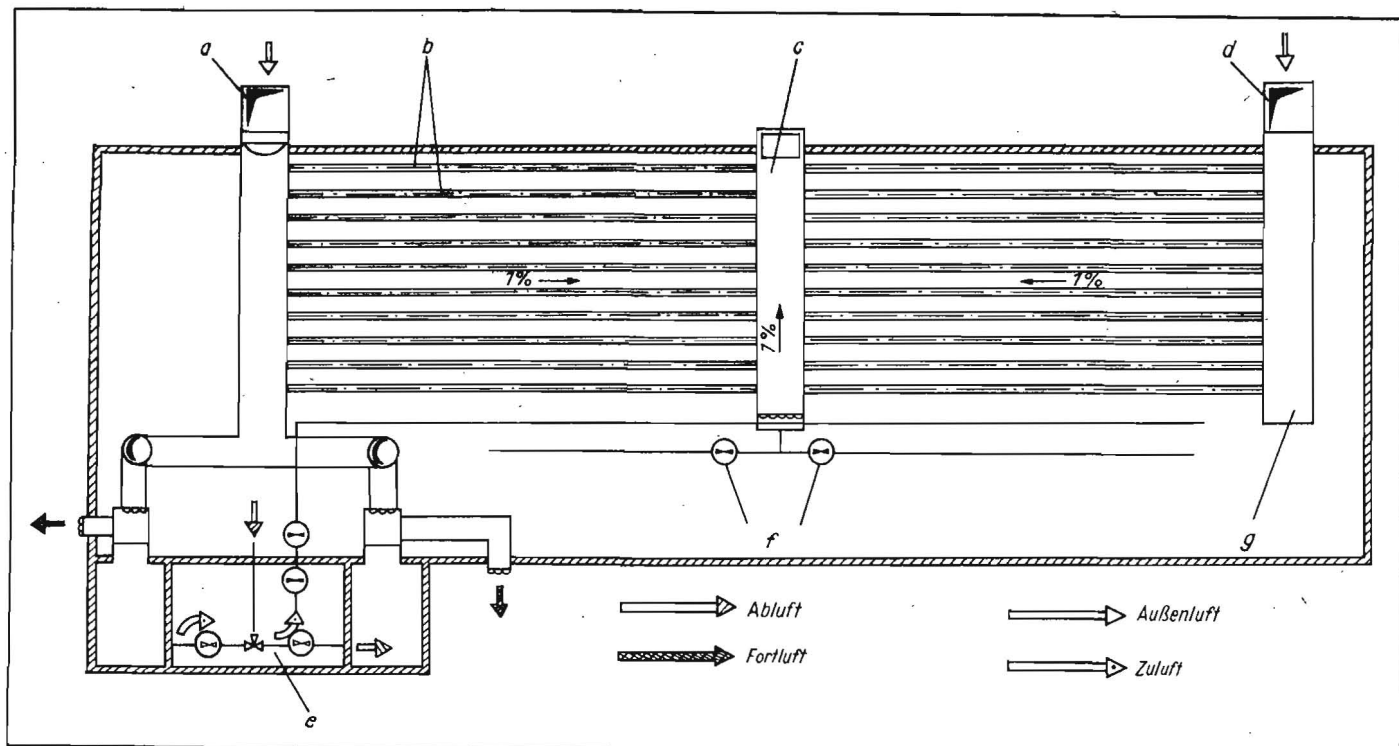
Grundriß des Putenstalls mit Prinzipdarstellung der Lüftungsanlage mit Erdreichwärmeübertrager; a Ansaugschacht (Sommer), b Wärmeübertragerrohre, c mittlerer Sammelkanal mit Pumpenschacht (Sommer), d Ansaugschacht, e Lüfterzentrale mit Thermospicher (Winterluftanlage), f Zuluftventilatoren mit Zentralrohr (Sommerluftanlage), g Sammelkanal
